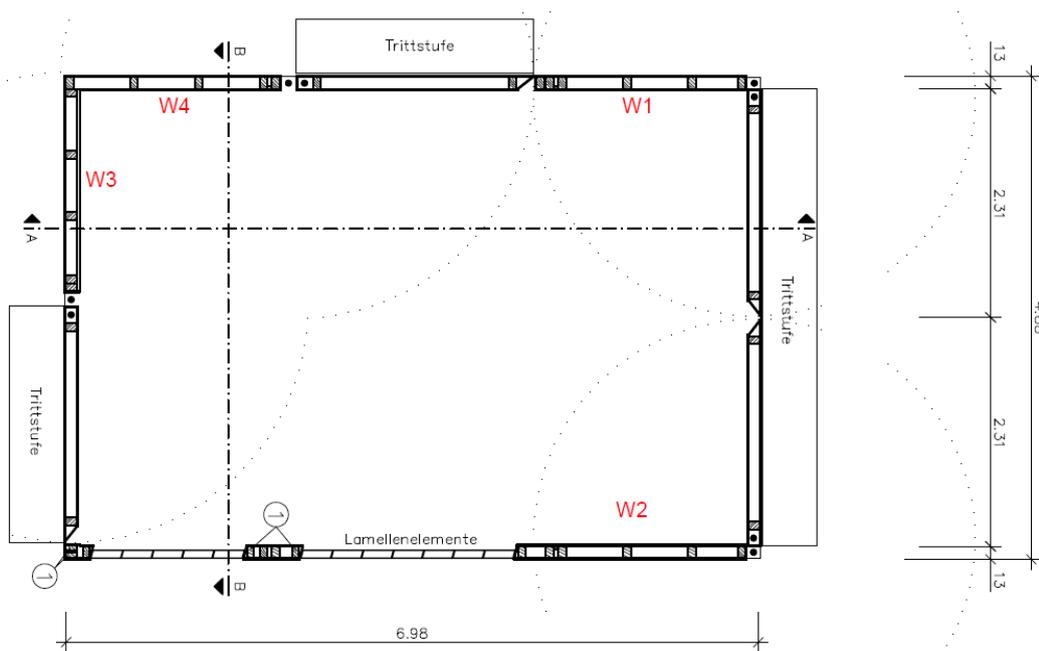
Grundriss des TIP-Pavillons
